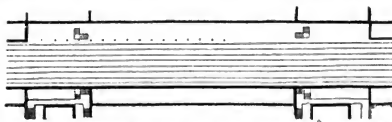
Grundriss einer Local- und Express-Station am Broadway.
